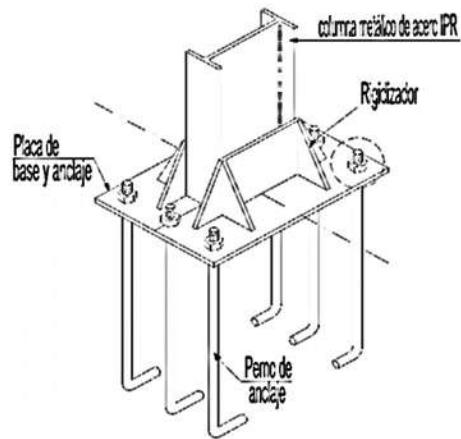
Columna metálica de acero IPR. Fuente: <http://www.arqhys.com/construccion/fotos/construccion>
